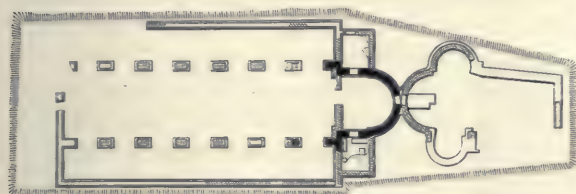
Grundriss von S. Sinfiorosa.
